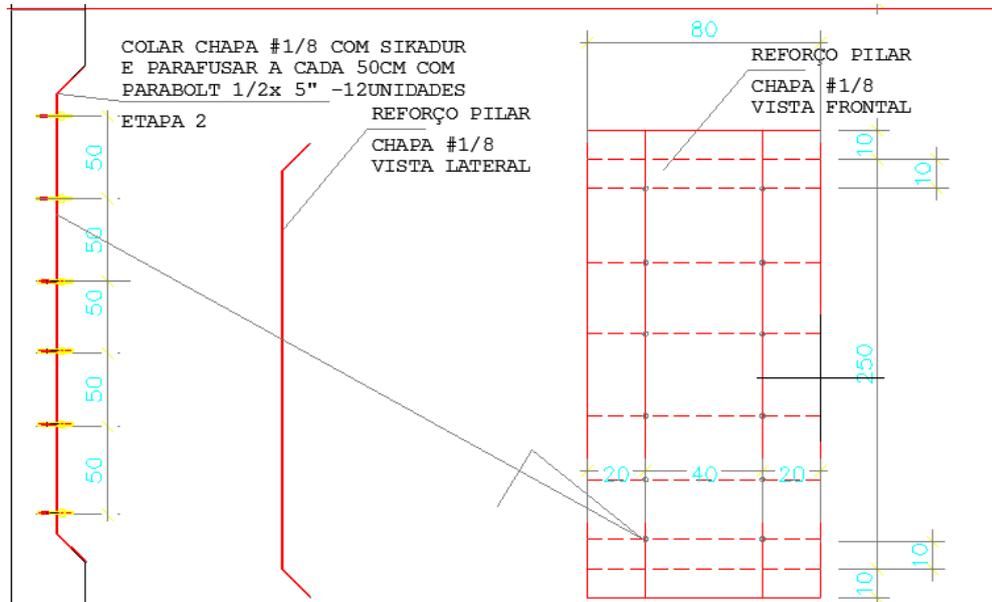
Detalhe esquemático para reforço de pilar com chapa metálica.
